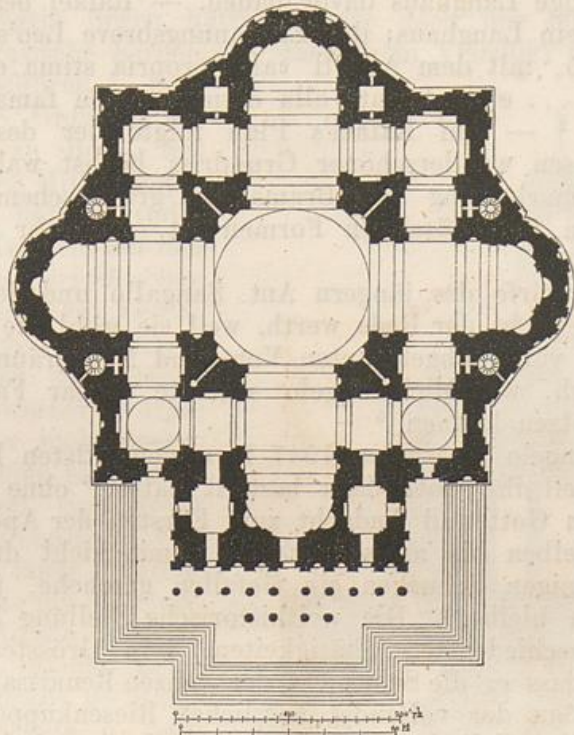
S. Peter. Michelangelo's Grundriss.
